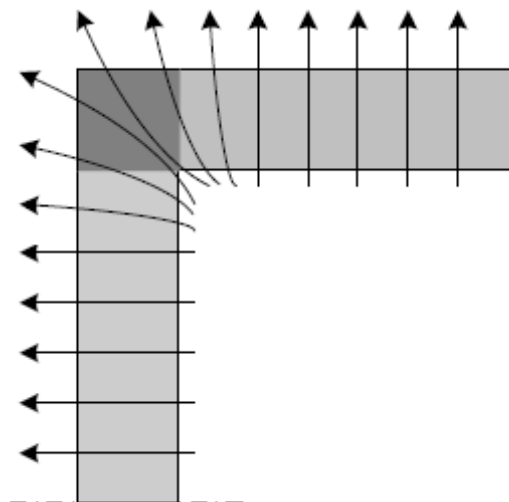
Ponte térmica na zona de um pilar de cunhal
